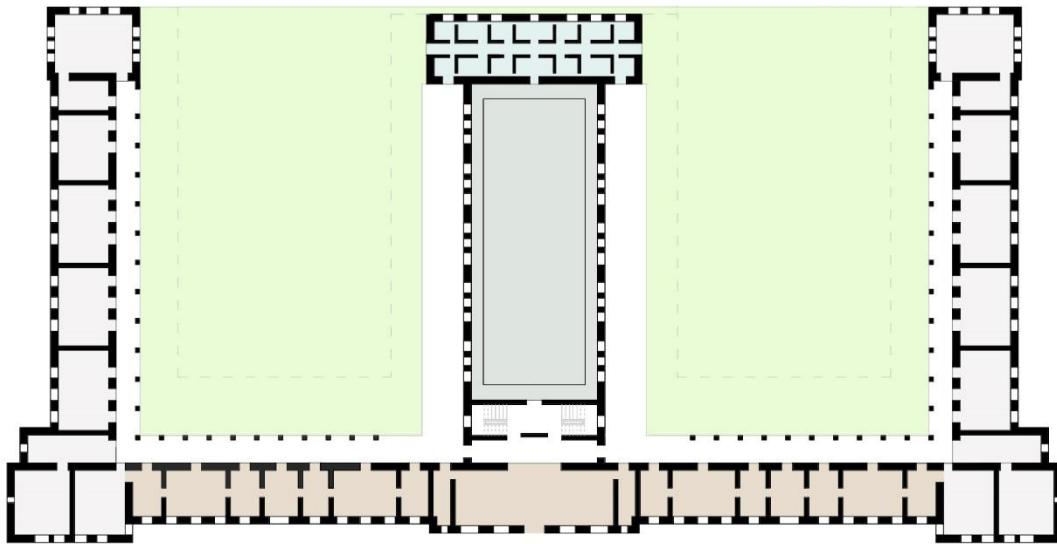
Liceu Camões. Planta Baixa piso 0, escala 1:500
